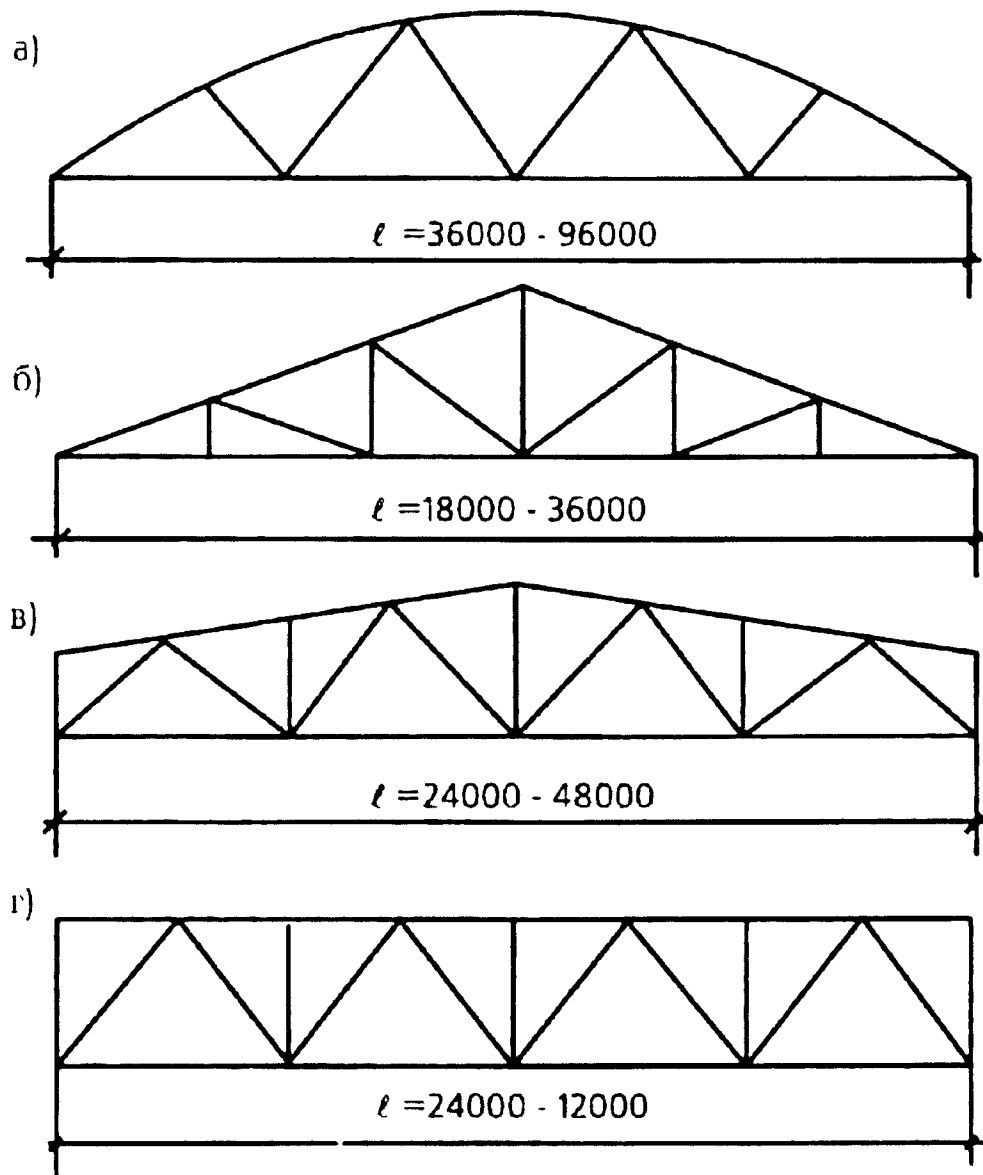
Стропильные фермы: а - сегментного очертания; б - треугольного очертания; в - трапецидального очертания; г - с параллельными поясами
